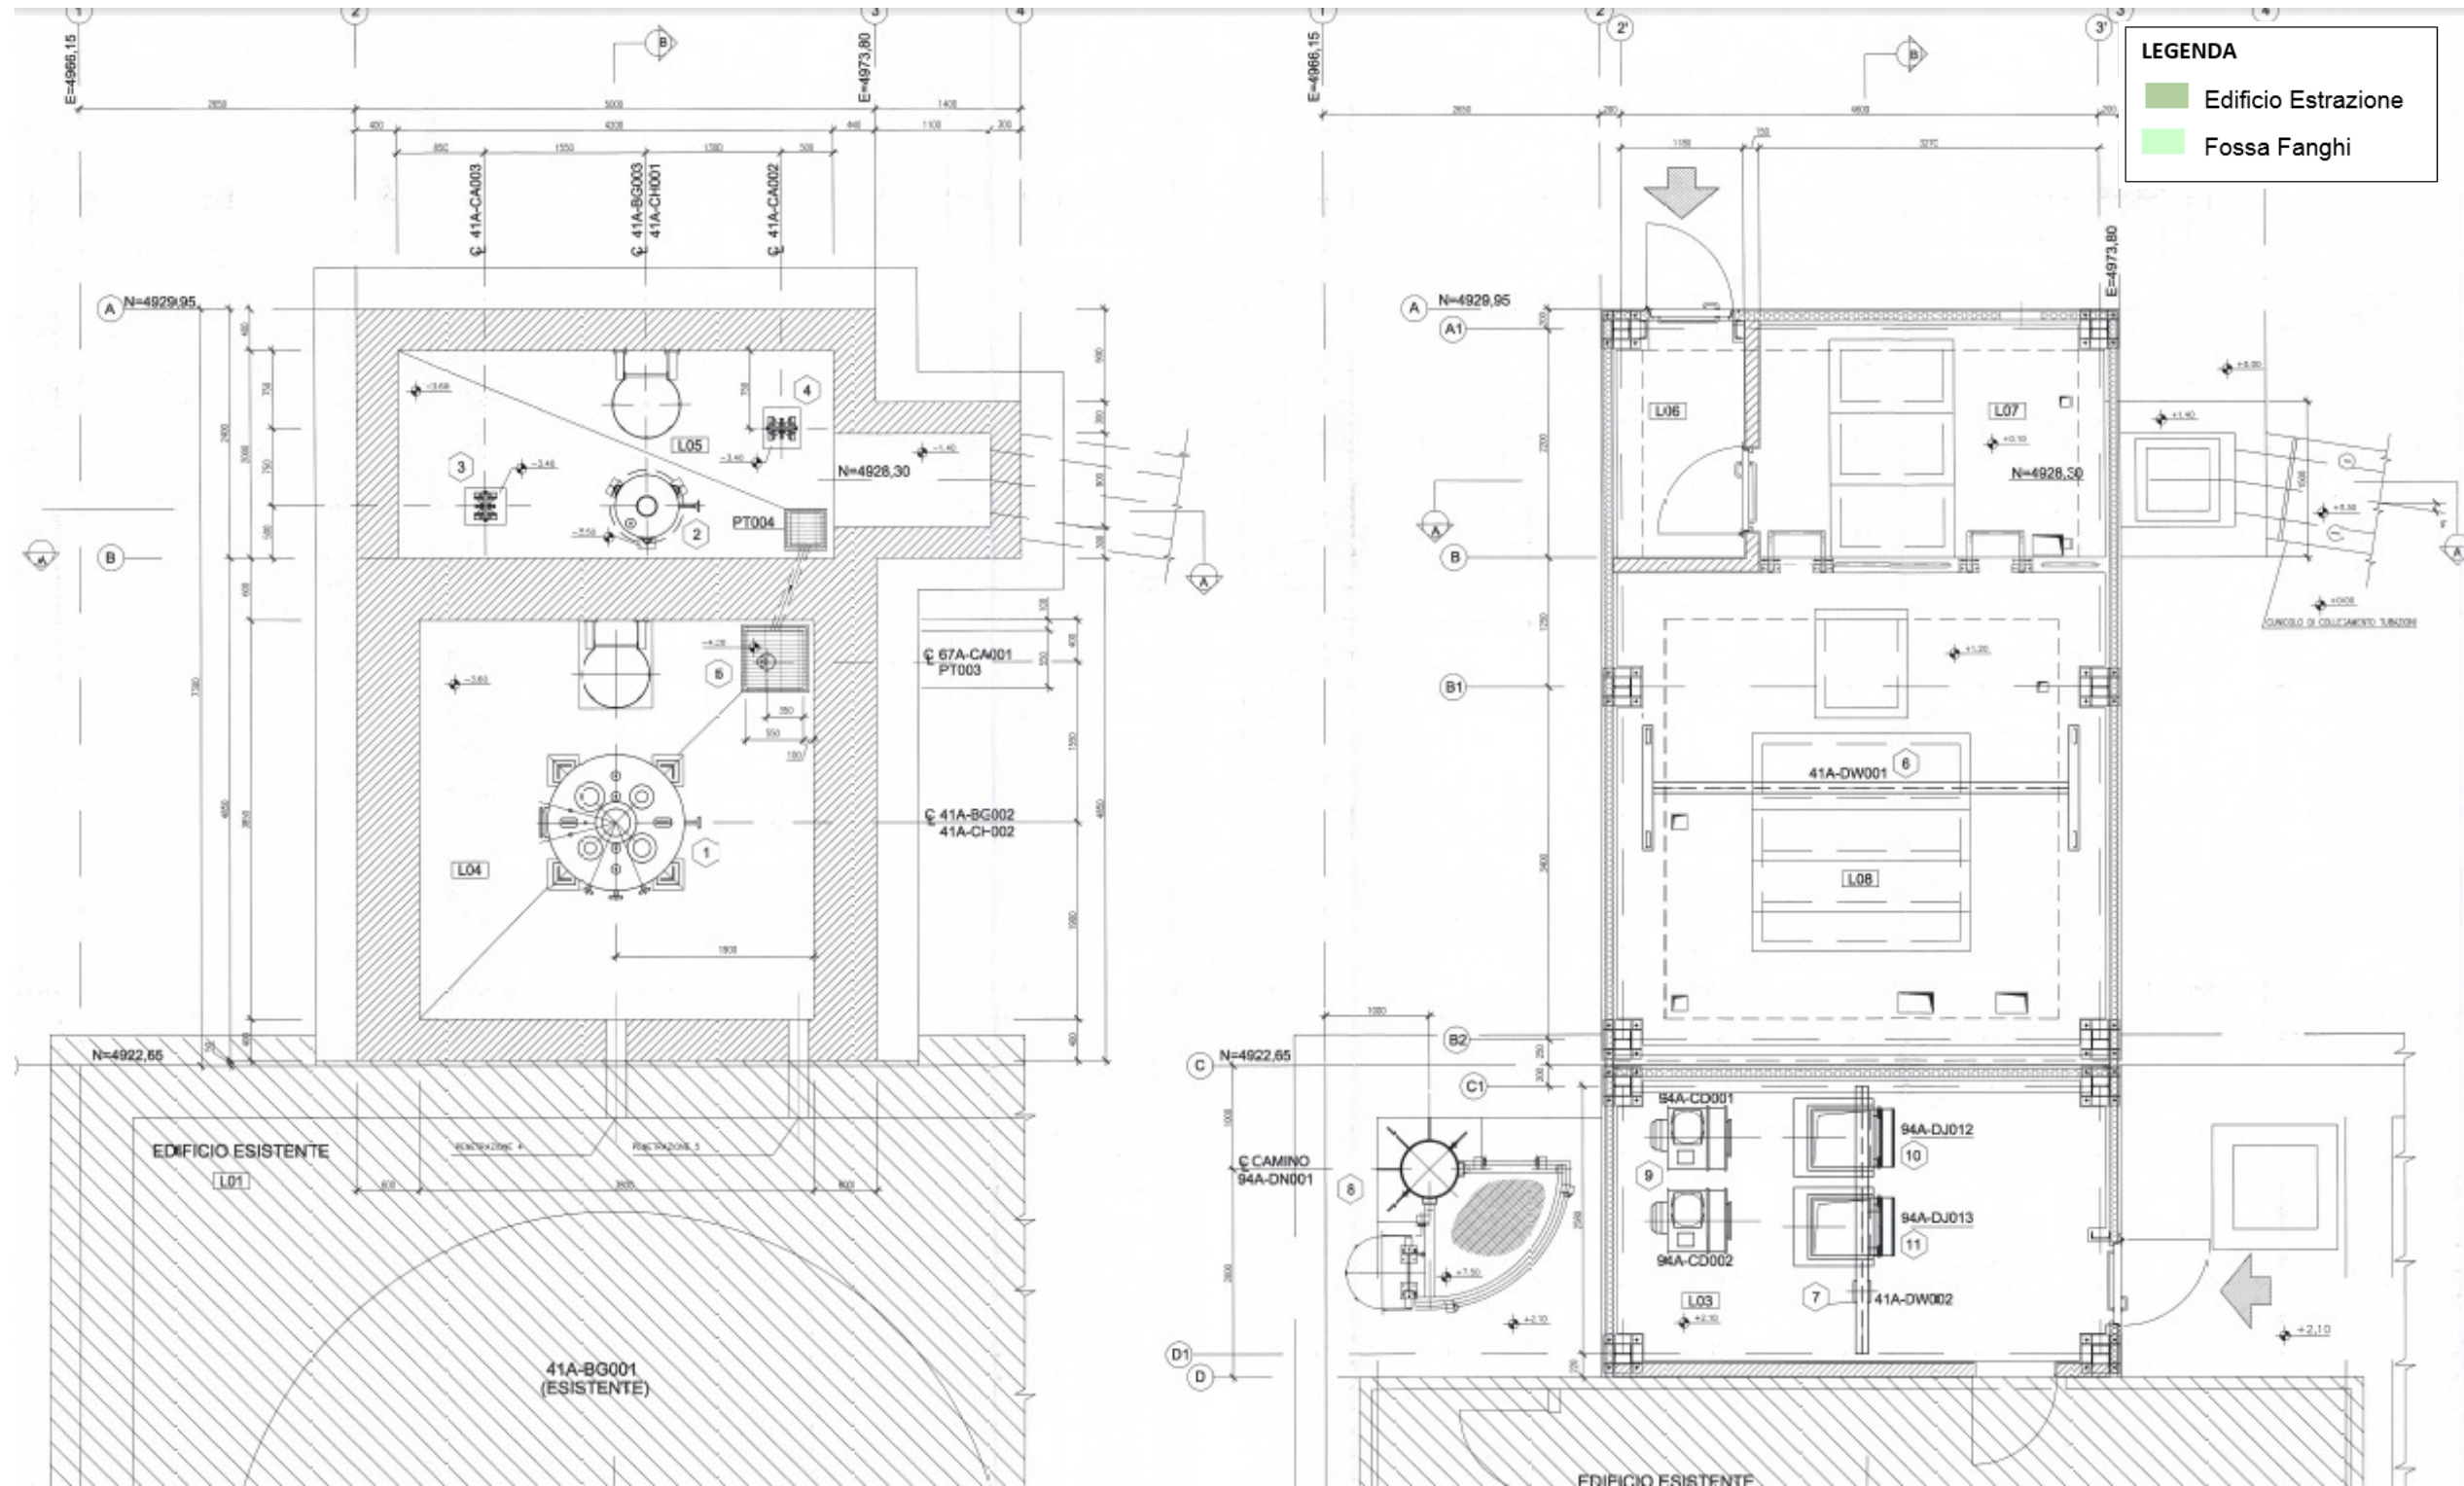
Edificio di Estrazione – Pianta piano interrato e Pianta piano campagna
